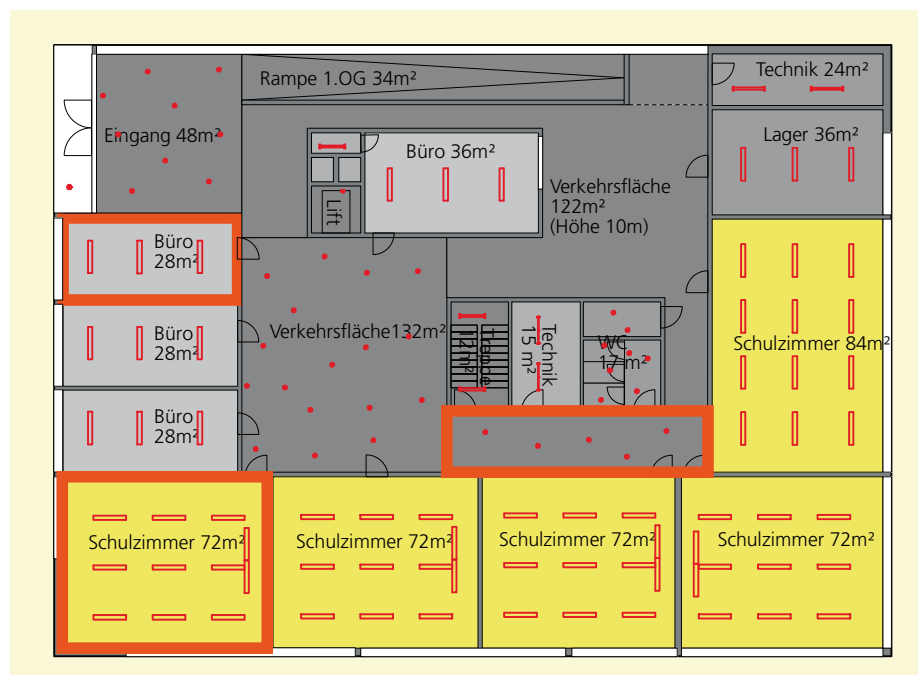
Grundriss eines typischen Geschosses im Beispielgebäude
